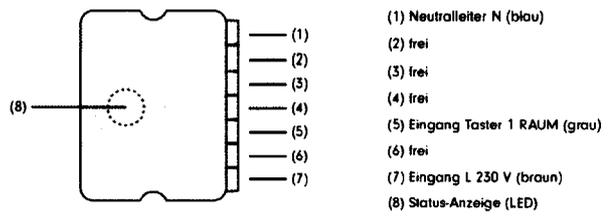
Anschlussplan Tasterklemme M (Gelb)
